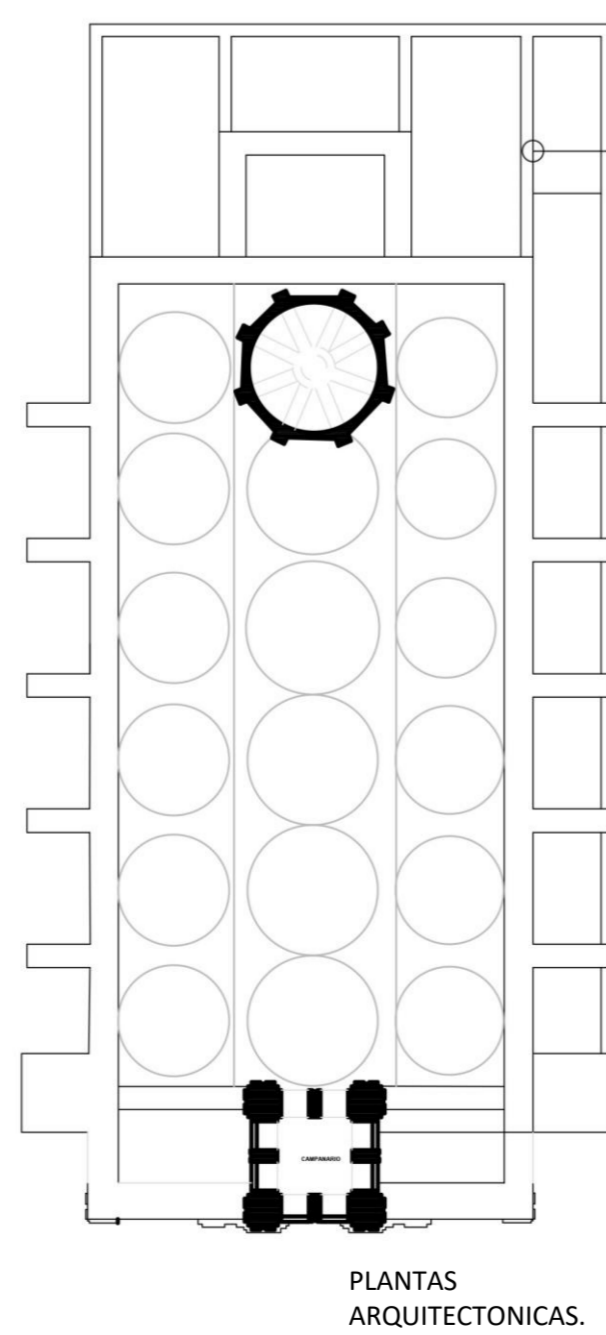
Planta arquitectónica alta | 2nd Floor plan
